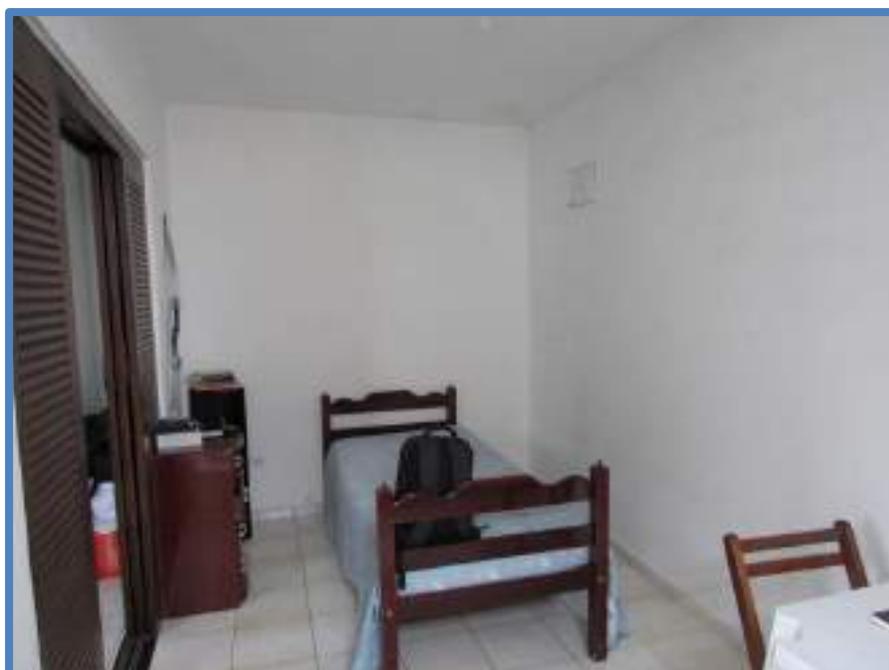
Casa, Primeiro Subsolo, Dormitório 02.
